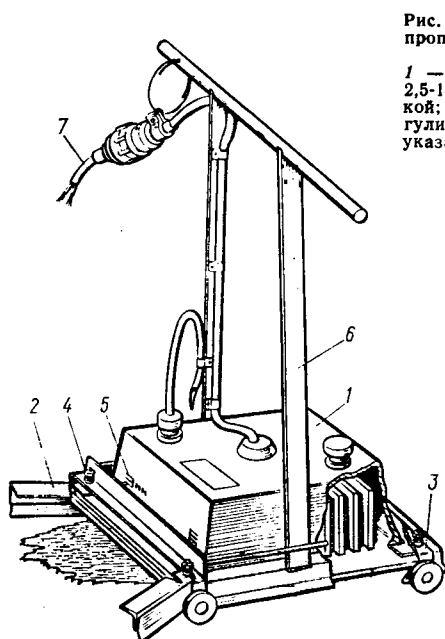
Рабочий орган для пропитки бетонных покрытий:
